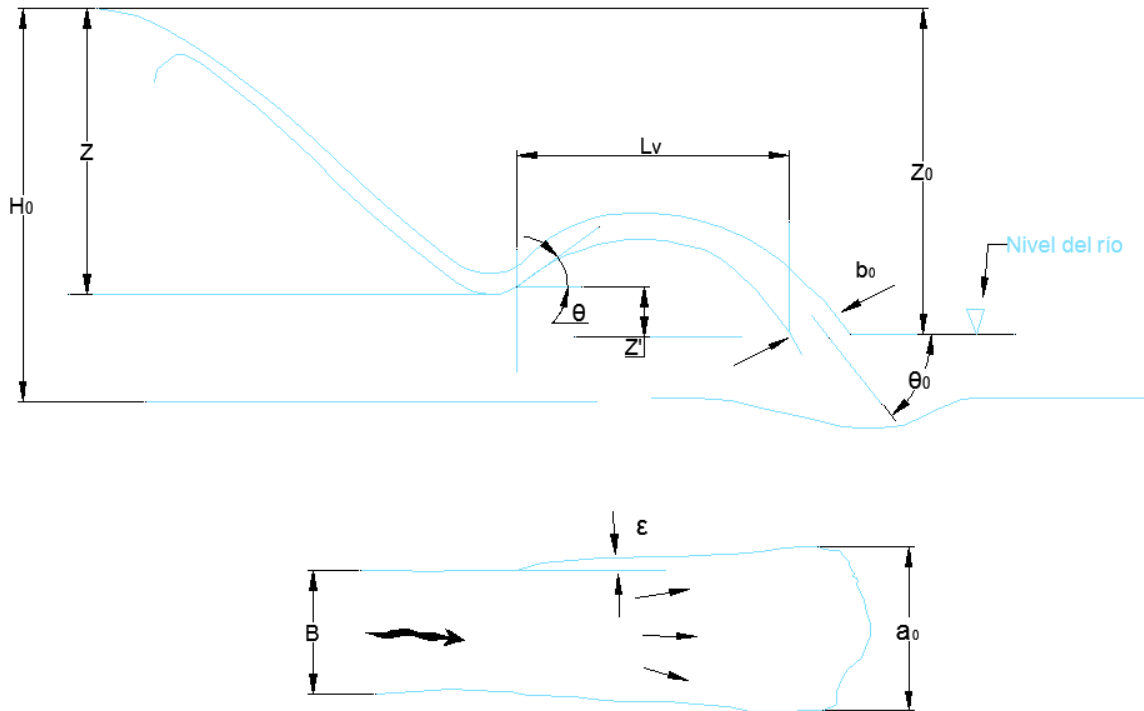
Geometría del chorro en las cubetas de lanzamiento
